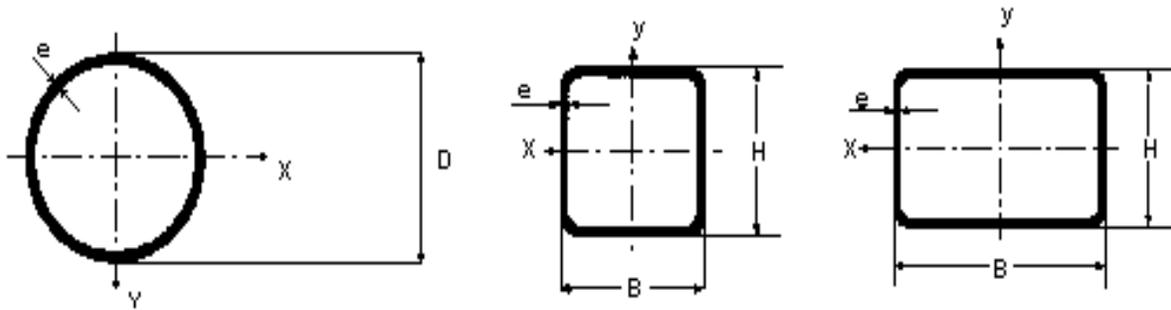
Tipos de tubos estructurales: redondos, cuadrados y rectangulares. Fuente en línea: [http://www.constructalia.com/espanol/productos/estructuras/tubos/tubo\\_estructural\\_rectangular\\_cuadrado\\_y\\_redondo](http://www.constructalia.com/espanol/productos/estructuras/tubos/tubo_estructural_rectangular_cuadrado_y_redondo)
